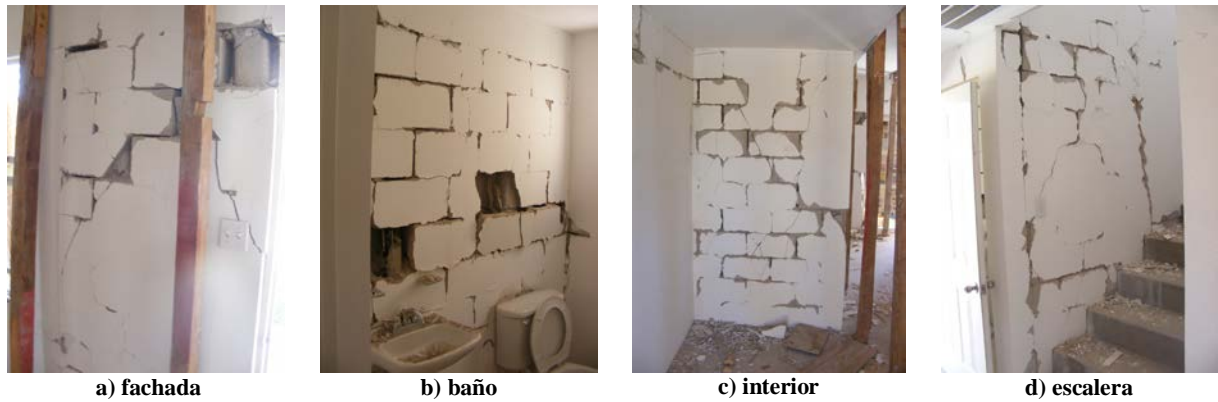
Daño observado en los muros en la dirección corta de la Vivienda C.
